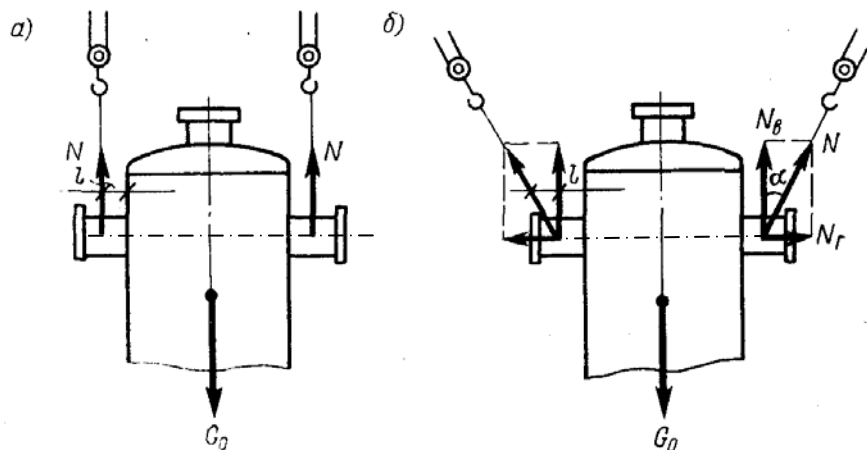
Схемы строповки оборудования при помощи монтажных штуцеров.
